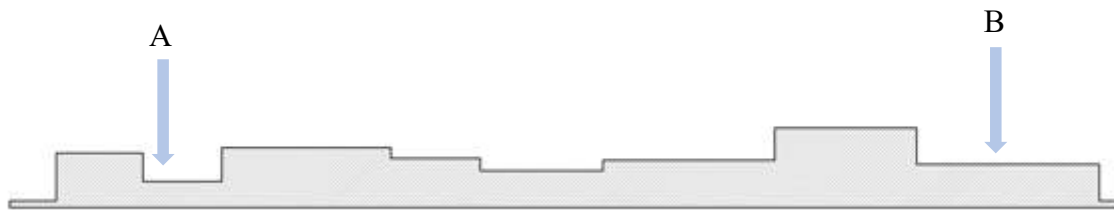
Alzado conceptual perfil sur. Acera sur Av. Universidad.
